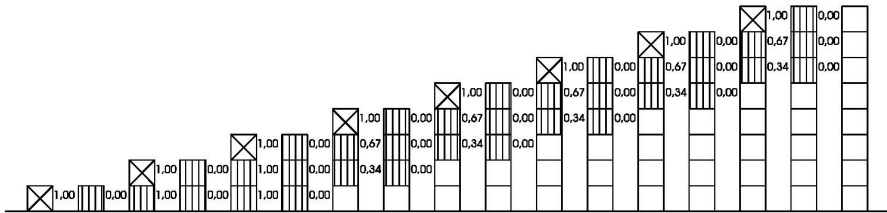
Factor de carga, en los puntales, con una planta cimbrada y dos recimbradas, en un edificio de ocho plantas, sobre solera infinitamente rígida.
